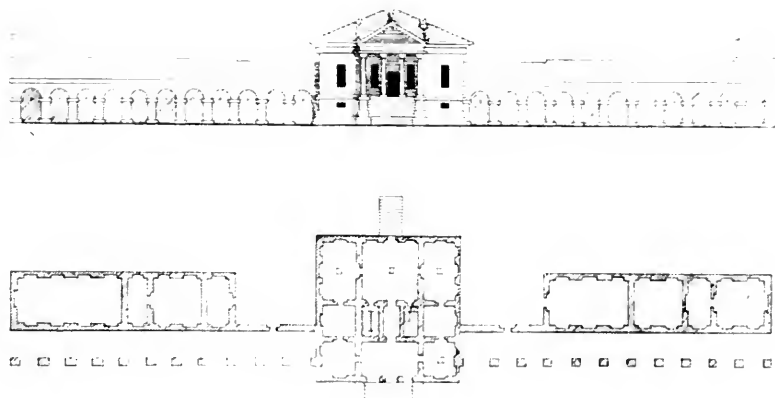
LA VILLA EMO. PLAN ET ÉLEVATION D'APRÈS UN DESSIN DE PALLADIO.
